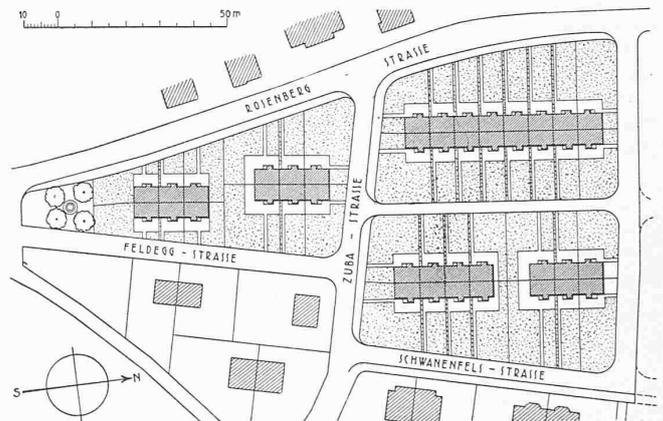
Wohnkolonie „Zuba“ in Neuhausen. — Lageplan 1: 200.
